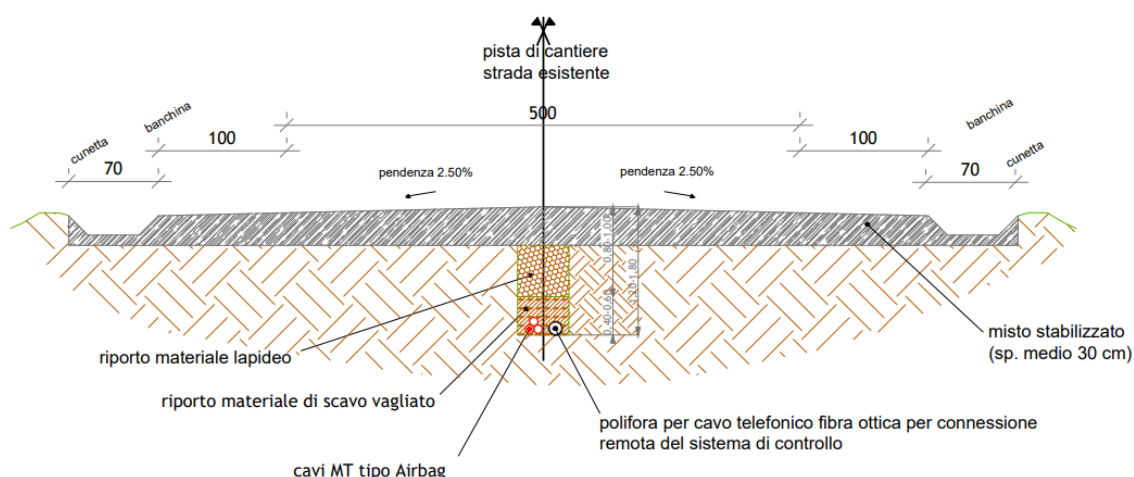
Sezione tipo - Pista di cantiere con cavidotto interrato
